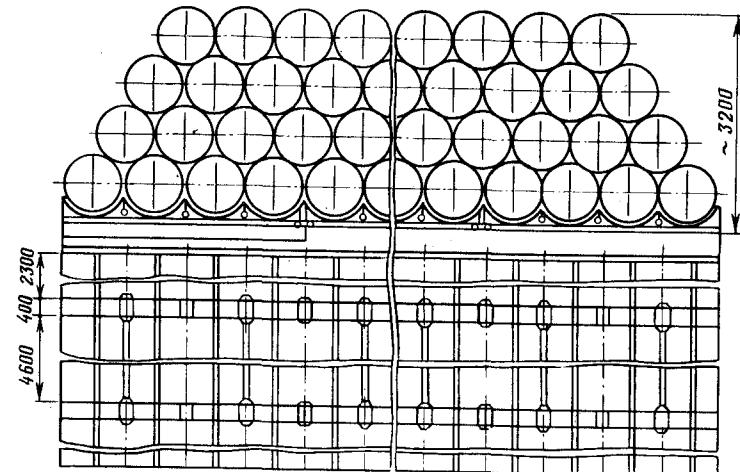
Сборно-разборный стеллаж СР-1421
